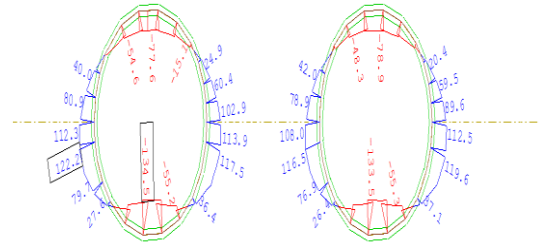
Эпюры моментов, возникающие в конструкции железобетонной обделки
